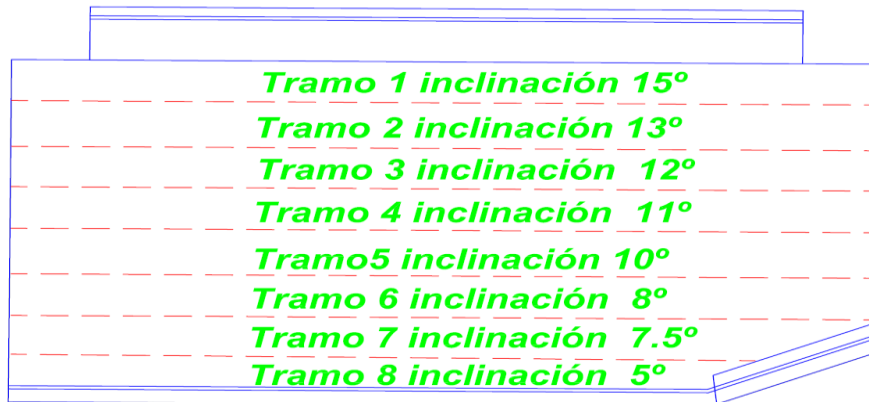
Vista en planta del multigimnasio y la inclinación de cada tramo
